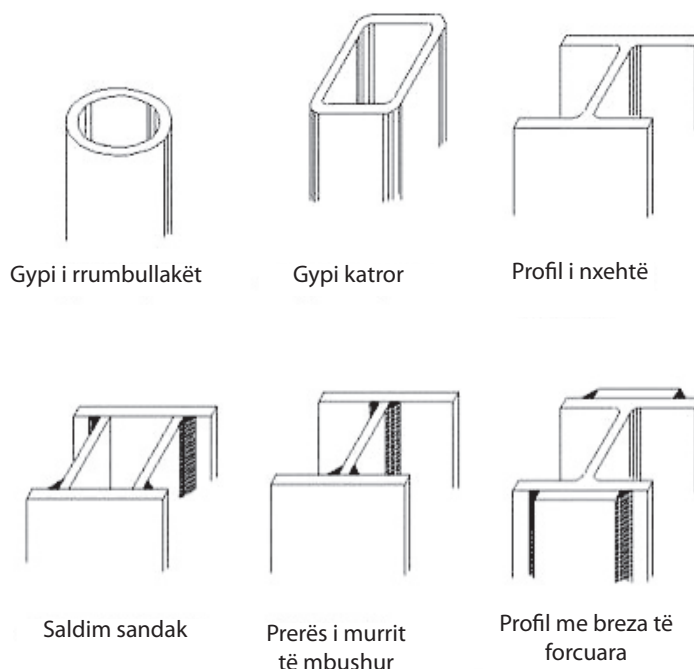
Tipe të ndryshme të shtyllave një pjesëshe
